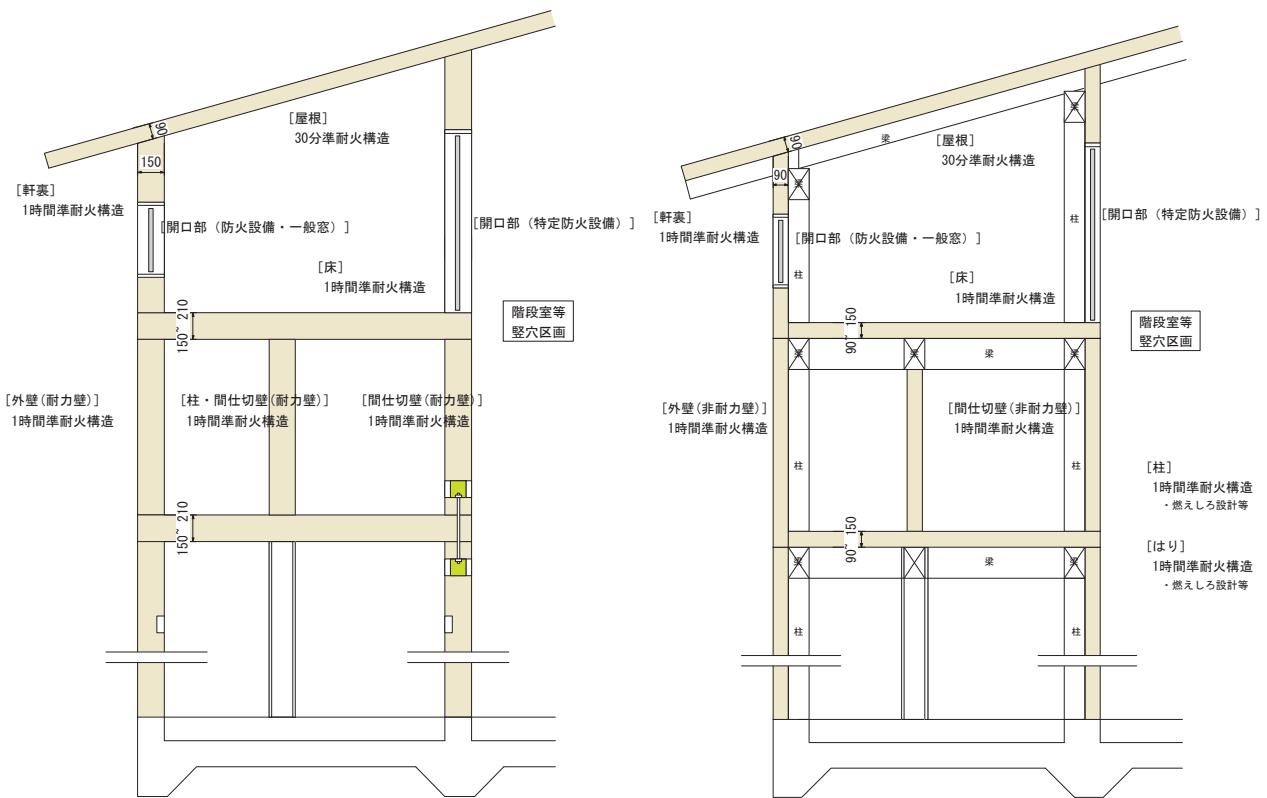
CLT 耐力壁・床・屋根による工法 図 3-5 柱・はり・CLT 非耐力壁・床・屋根による工法
